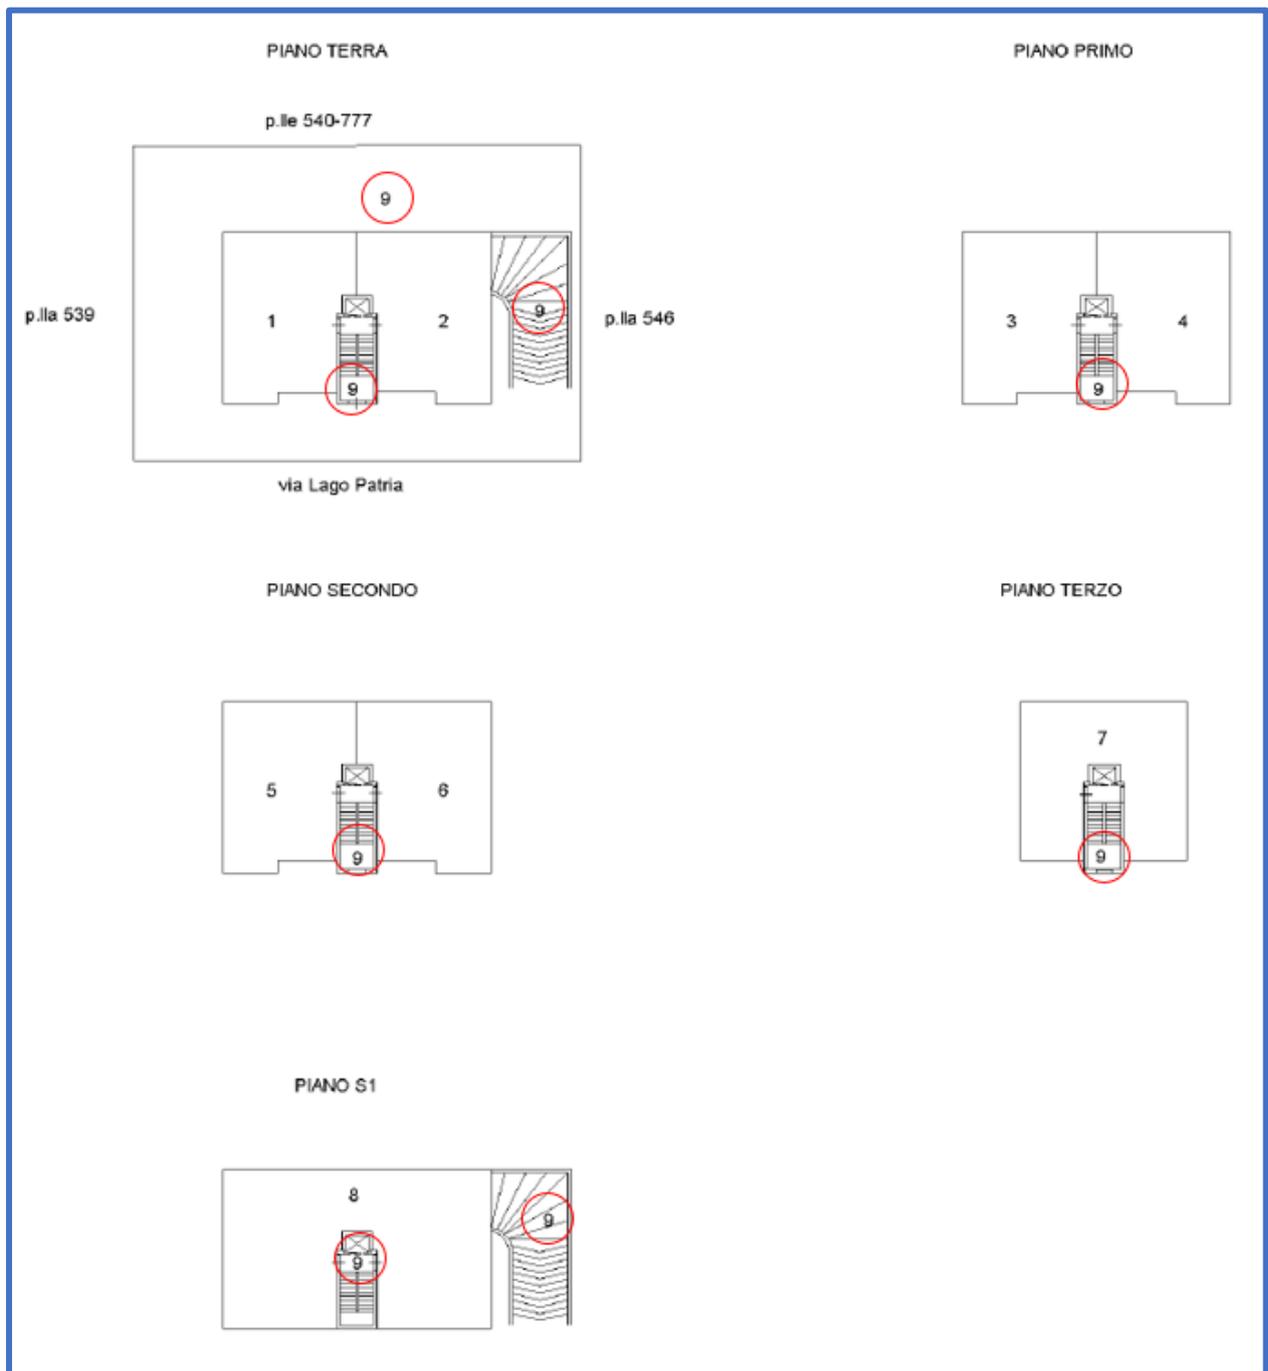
Estratto Elaborato Planimetrico NCEU Fog. 5 P.la 5447
